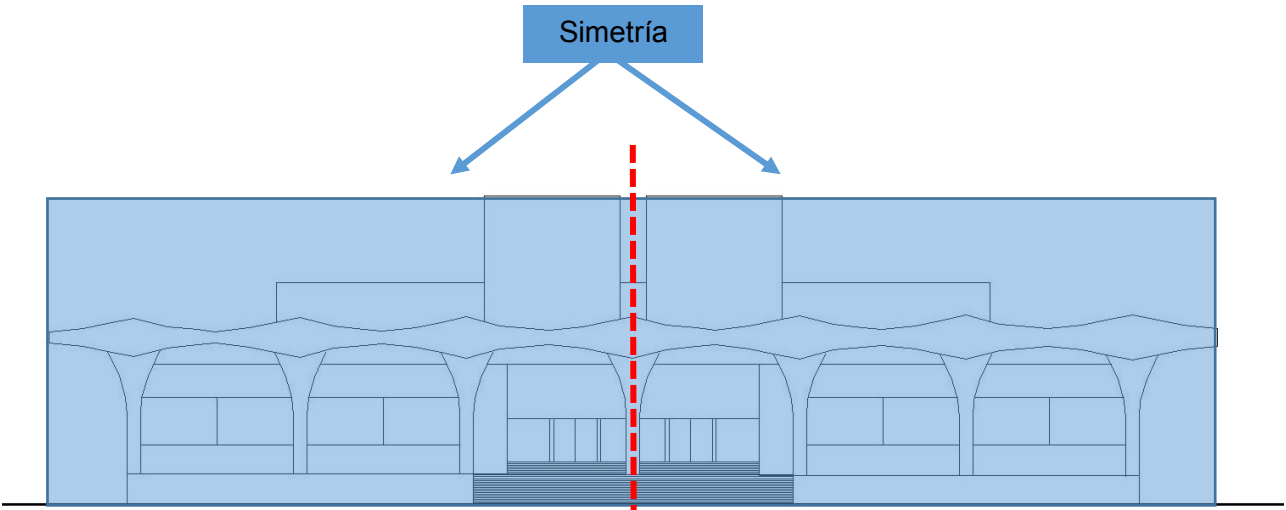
Representación de simetría bilateral y pauta lineal en la fachada principal del Teatro Presidente de San Salvador. Fuente: Elaborado por los autores.
